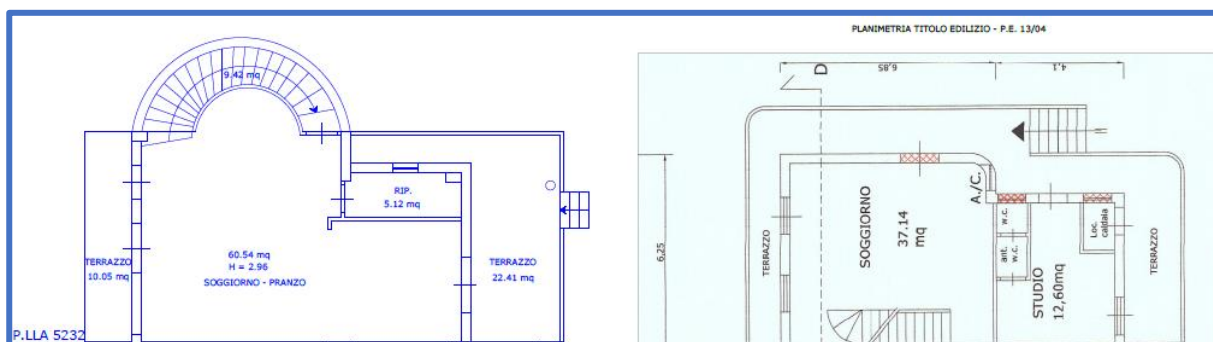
Fog. 175 P.lla 5232 sub 1 – sub 2 Piano Terra – Sovrapposizione P.E. 13/2004
